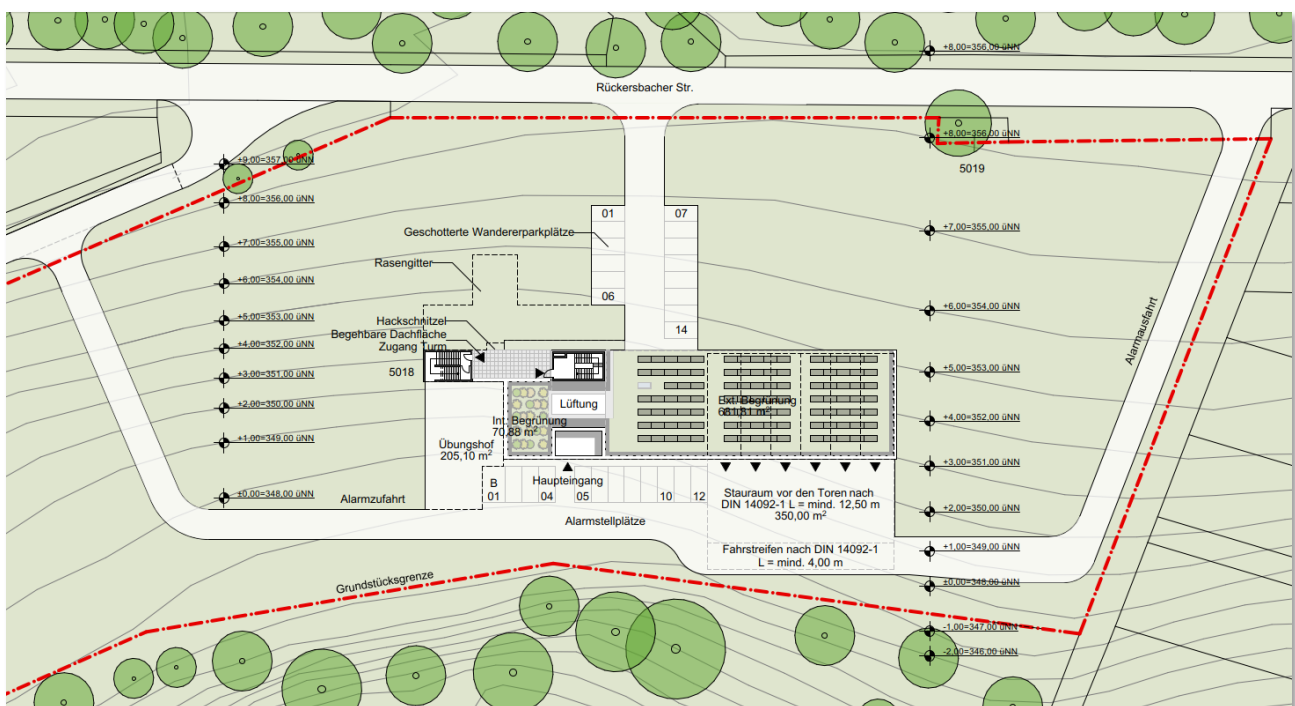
Lageplan Feuerwehr, Stand 05/2023 [4]
